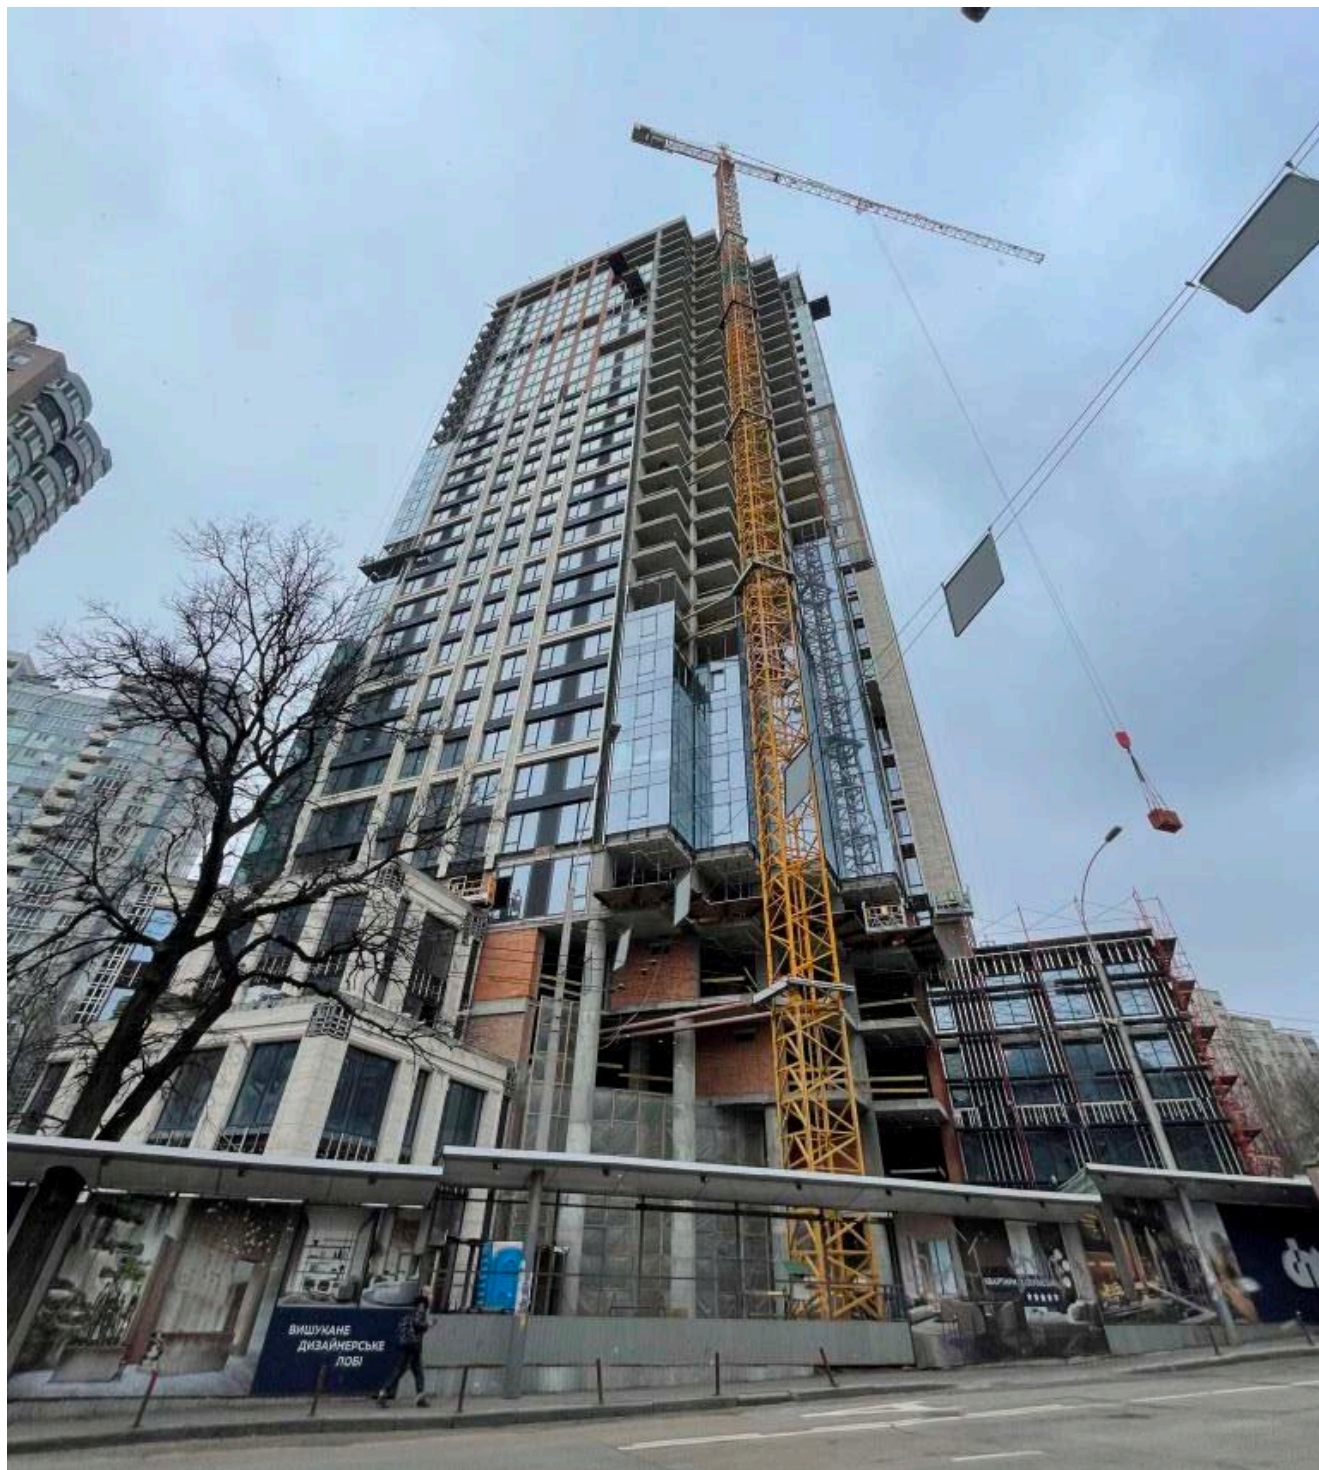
Загальний вигляд Фасад з боку вул. Антоновича
